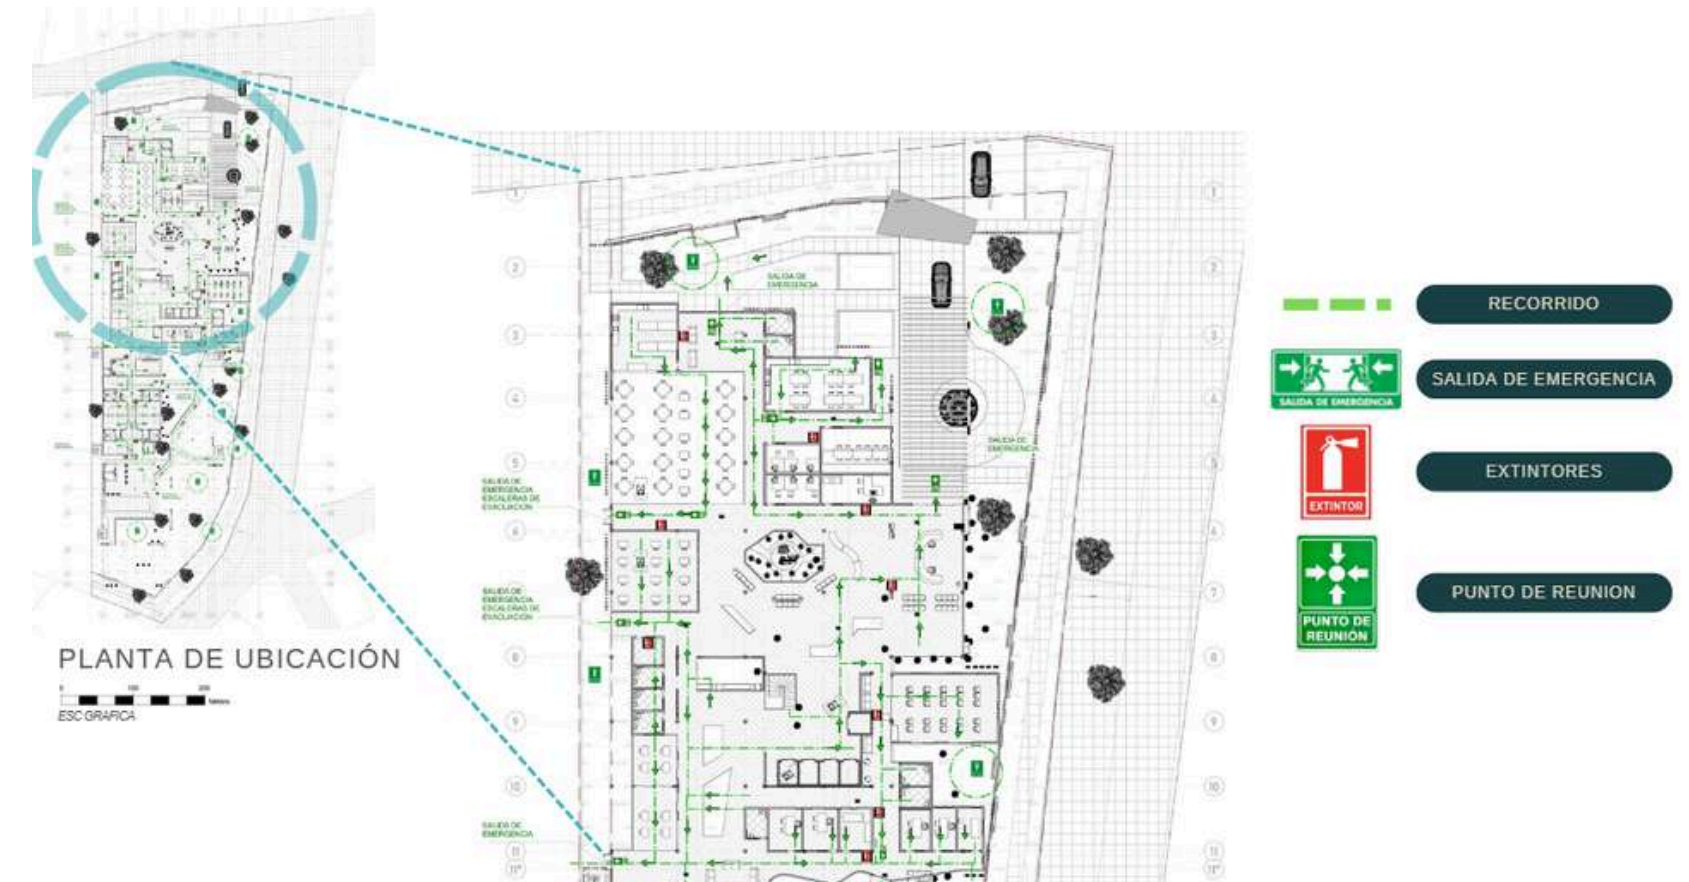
Planta Arquitectónica Evacuación Nivel 1.
